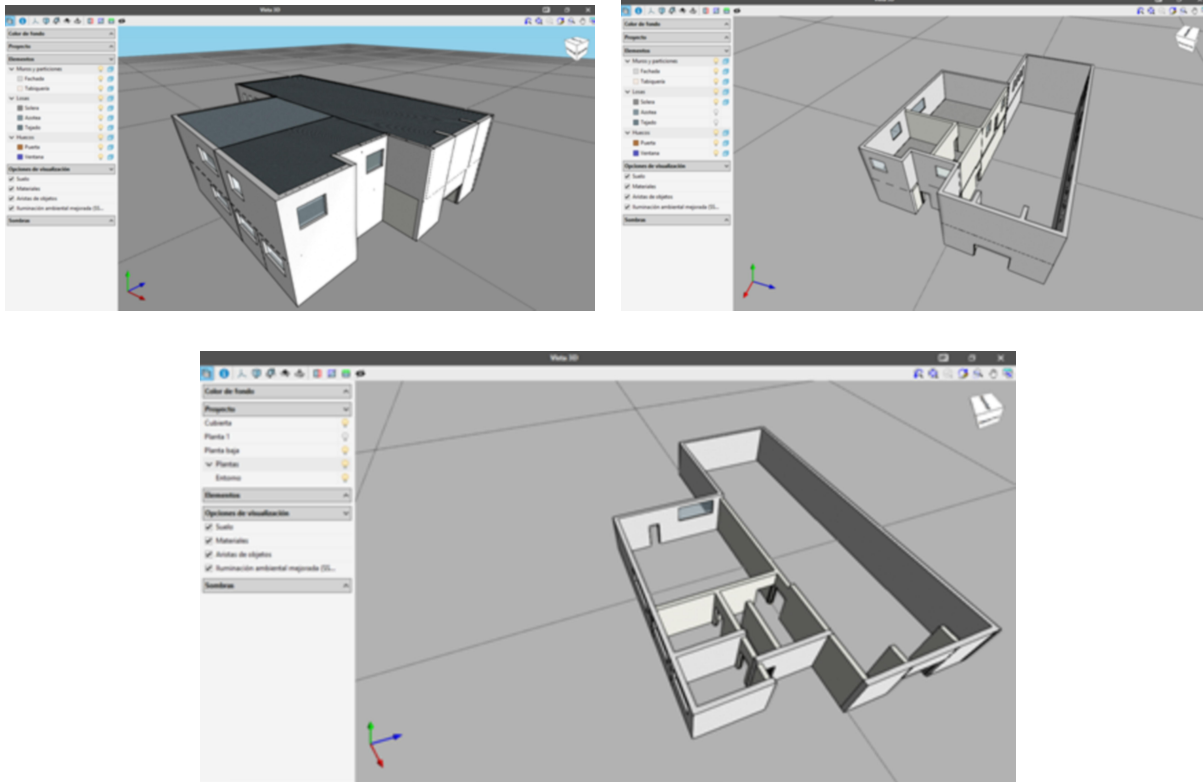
Vista 3D del edificio de operación de la Planta Luis Prieto Gómez. Vista general (superior izquierda), planta superior (superior derecha), planta inferior (inferior)
